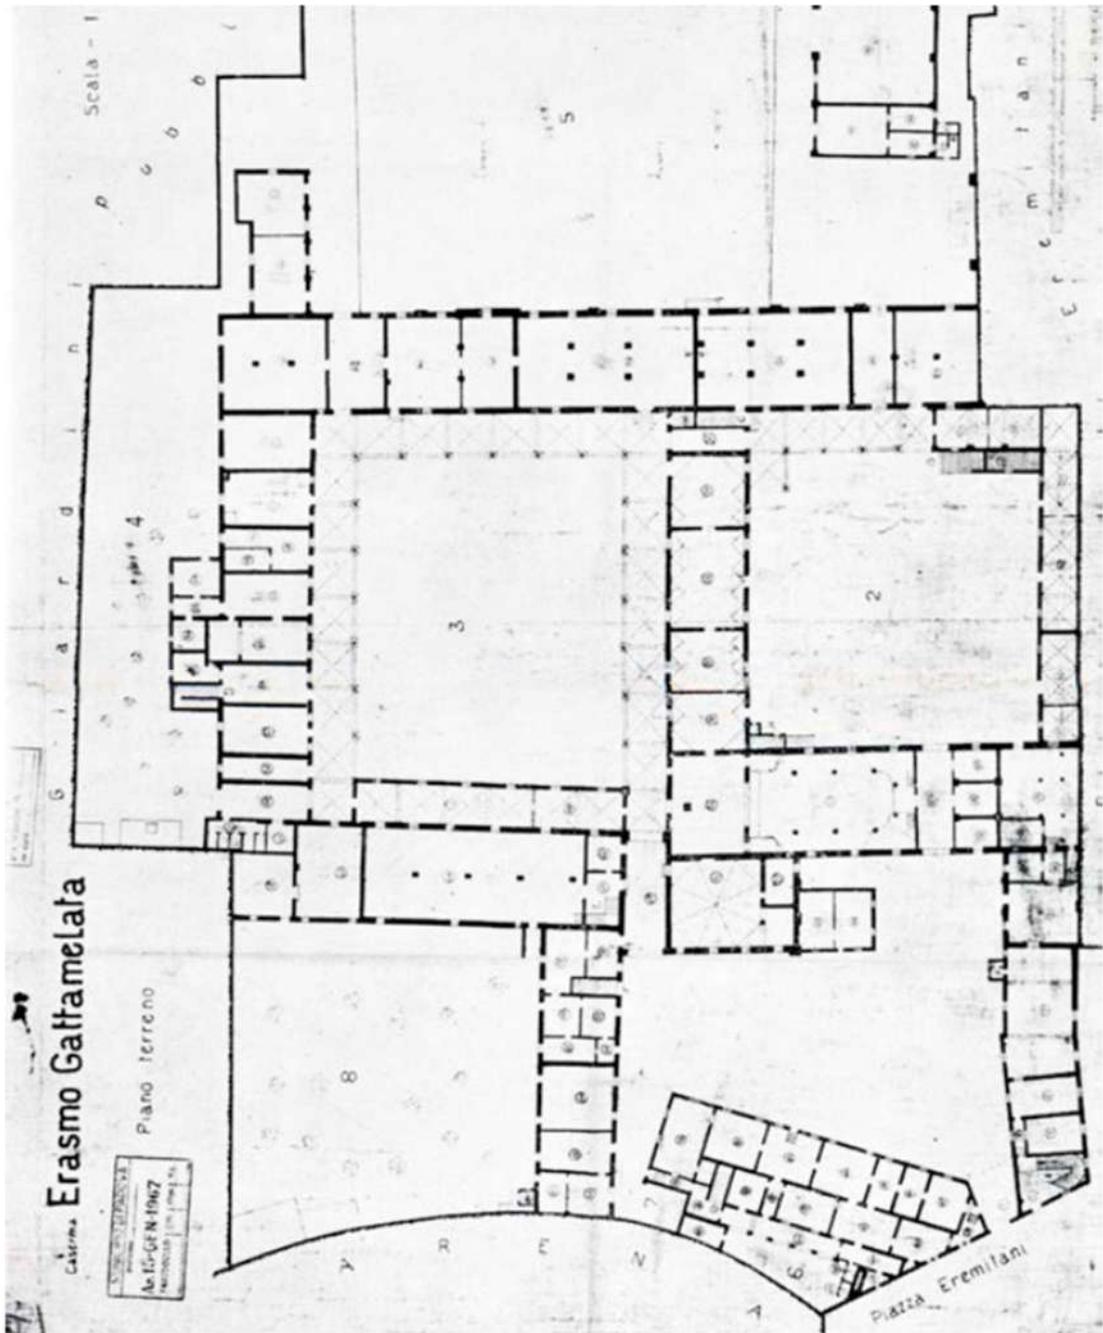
Planimetria Caserma Gattamelata piano Terra 1937
